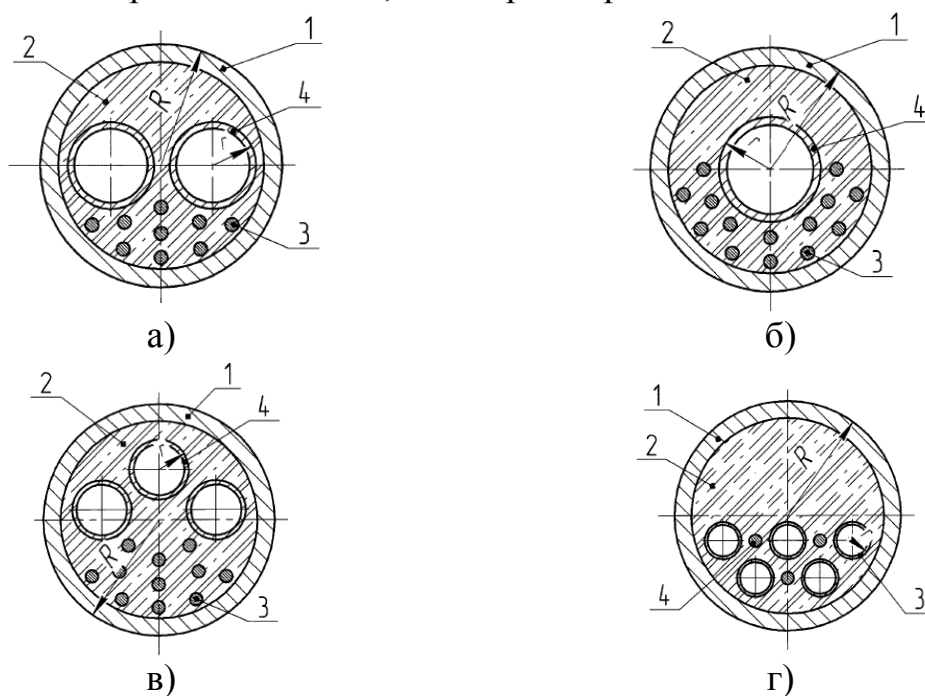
Варианты трубобетонной предварительно напряженной балки
